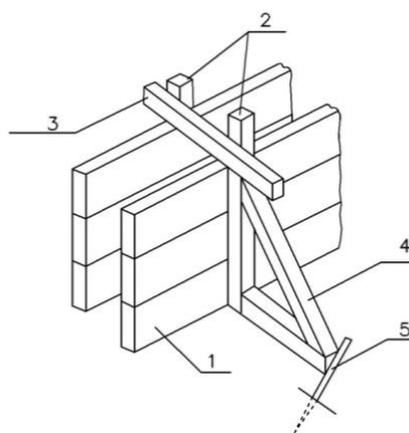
Деревянная разборно-переставная опалубка для фундамента:
